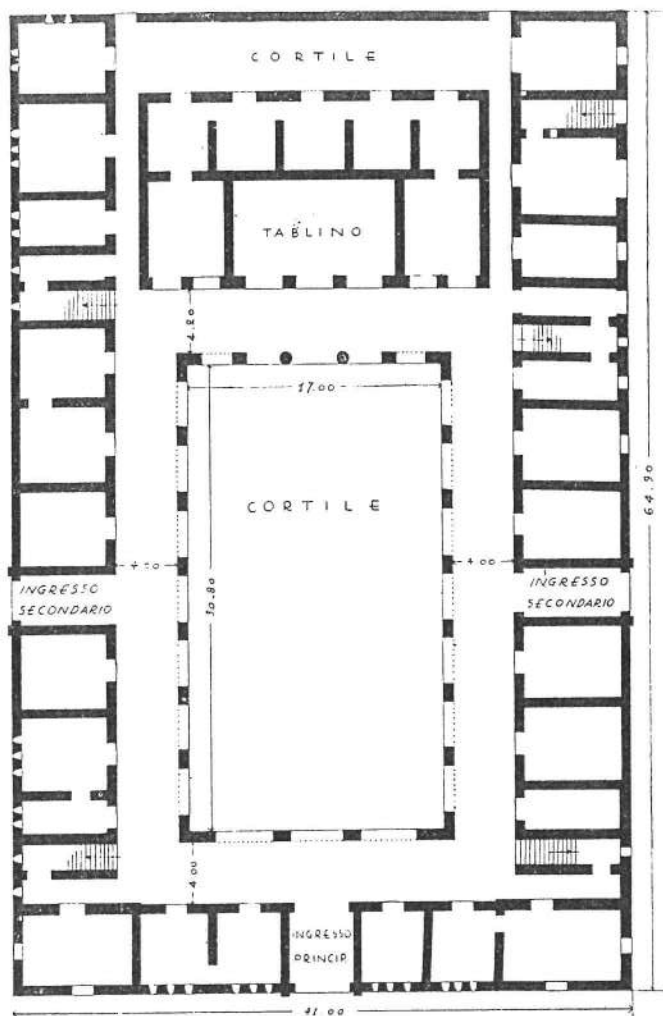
CASERMA DEI VIGILI: PIANTA
